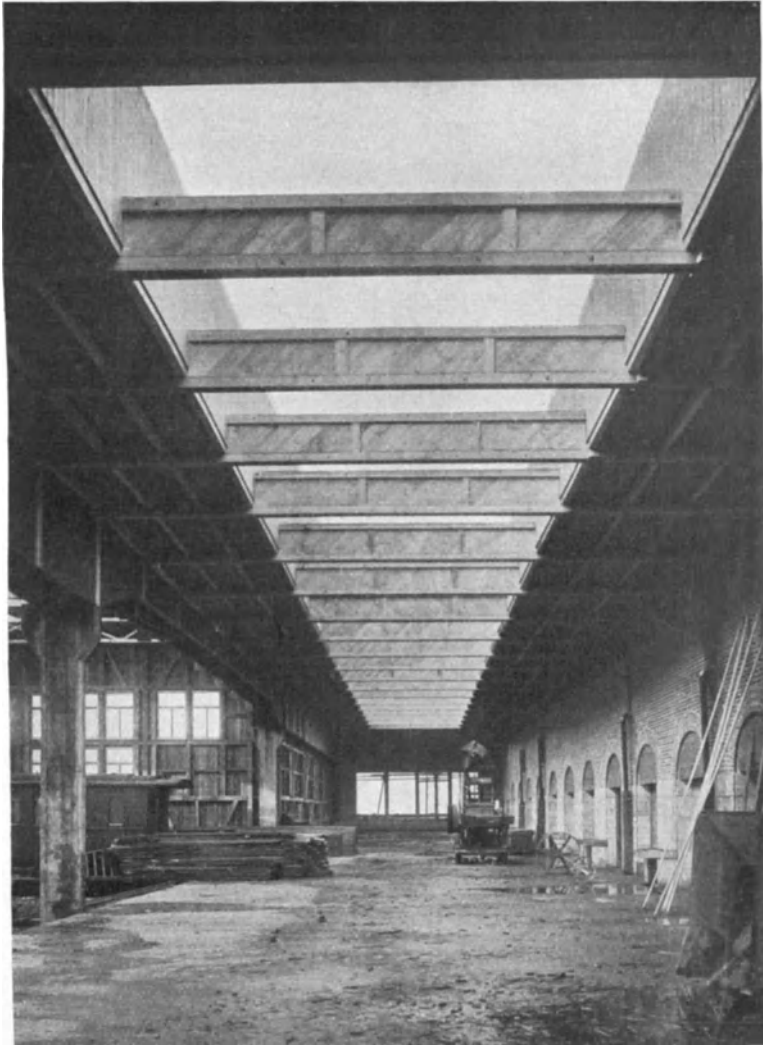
Innenansicht des Kopfbahnsteigs der Bahnpostanlage am Rosenstein.
